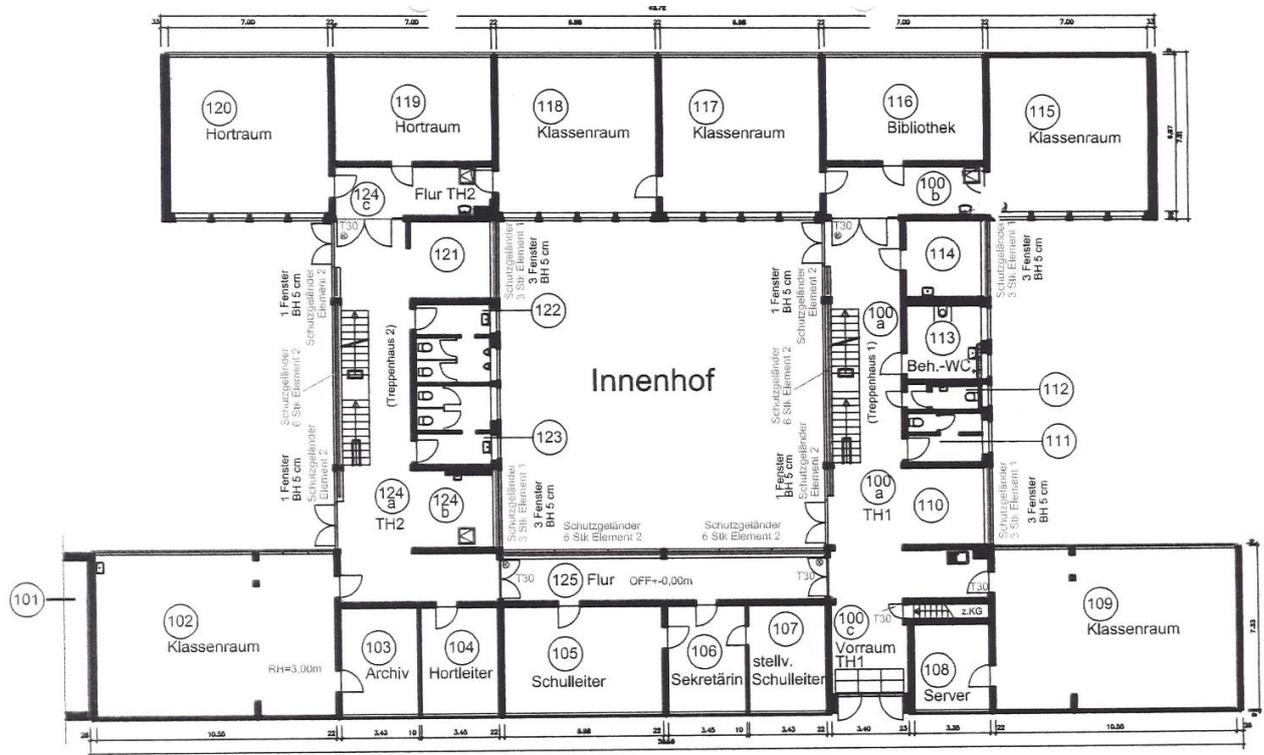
1. Bauabschnitt, Erdgeschoss Schulgebäude
